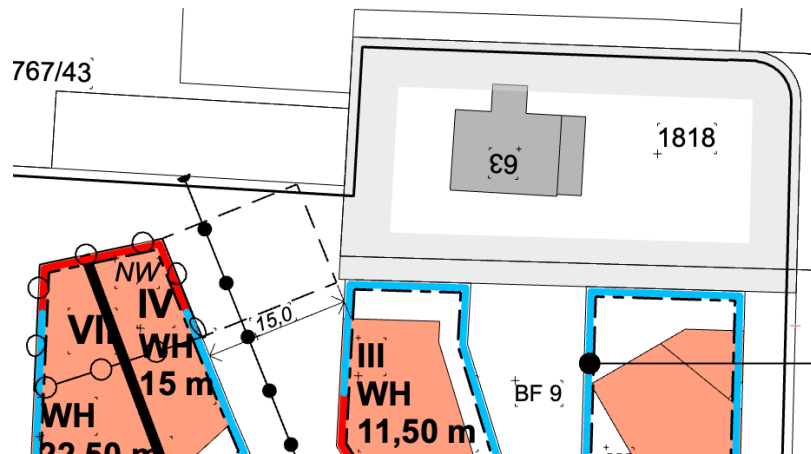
Abstandsflächen im nordwestlichen Bereich WA Süd(1)
